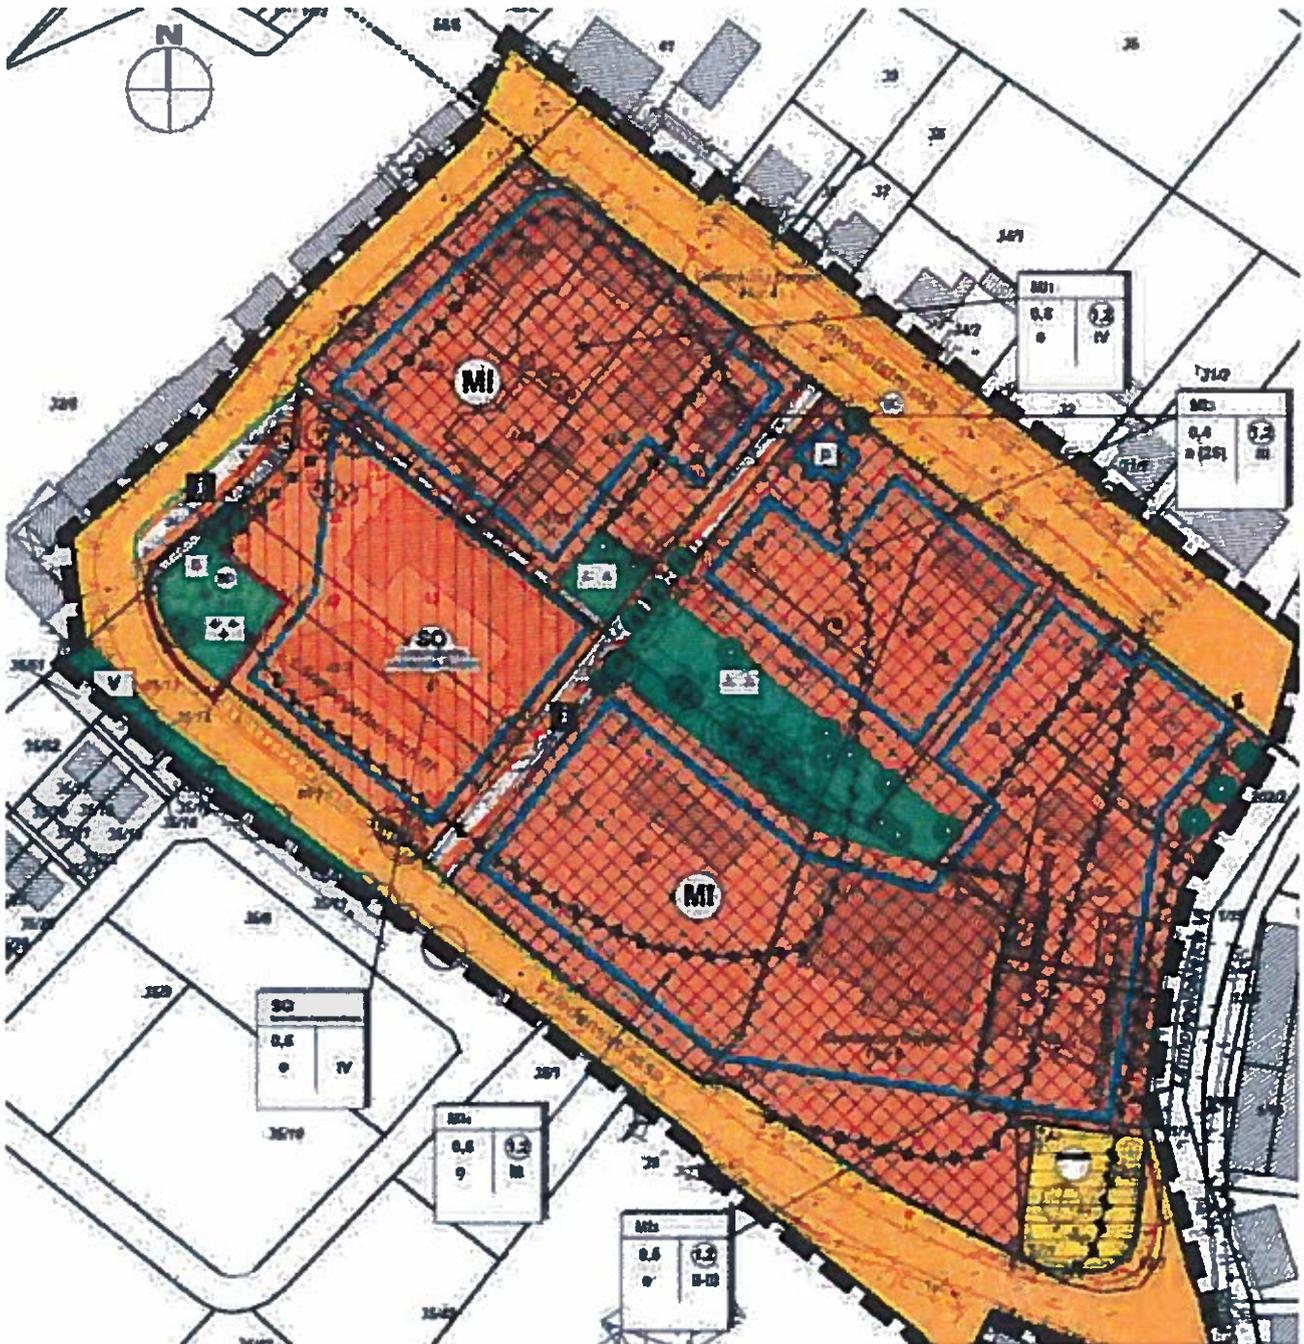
Planzeichnung Ursprungsplan, ohne Maßstab
